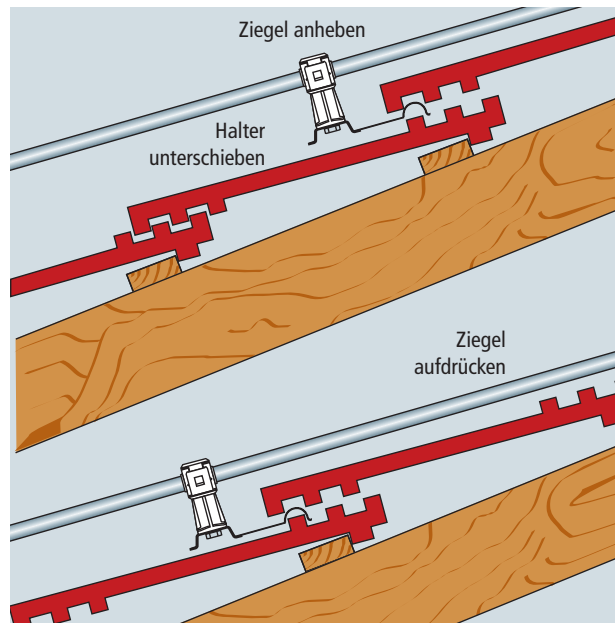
Dachleitungshalter zum Einhängen in den unteren Falz bei Pfannendächern
